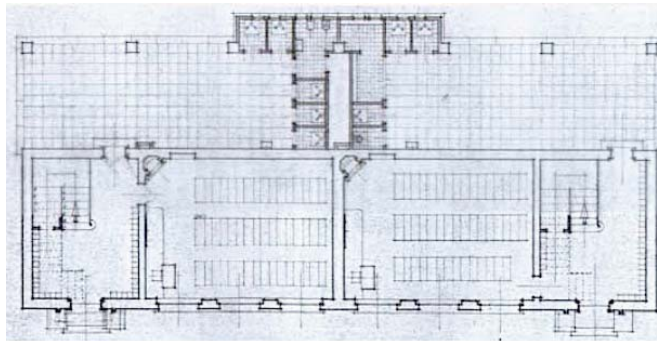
Escola tipo (dois pisos), Plano dos Centenários, planta R/C
